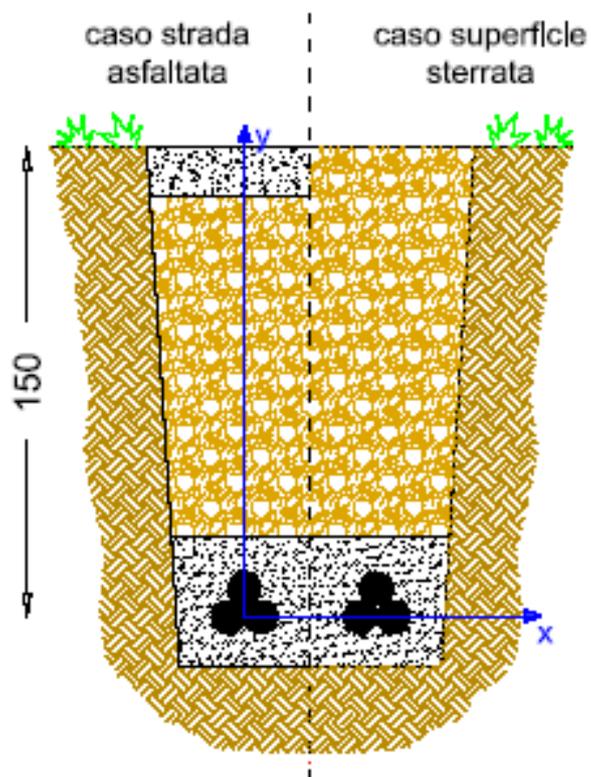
Schema di posa con indicazione della profondità minima dei cavi rispetto al piano di campagna
